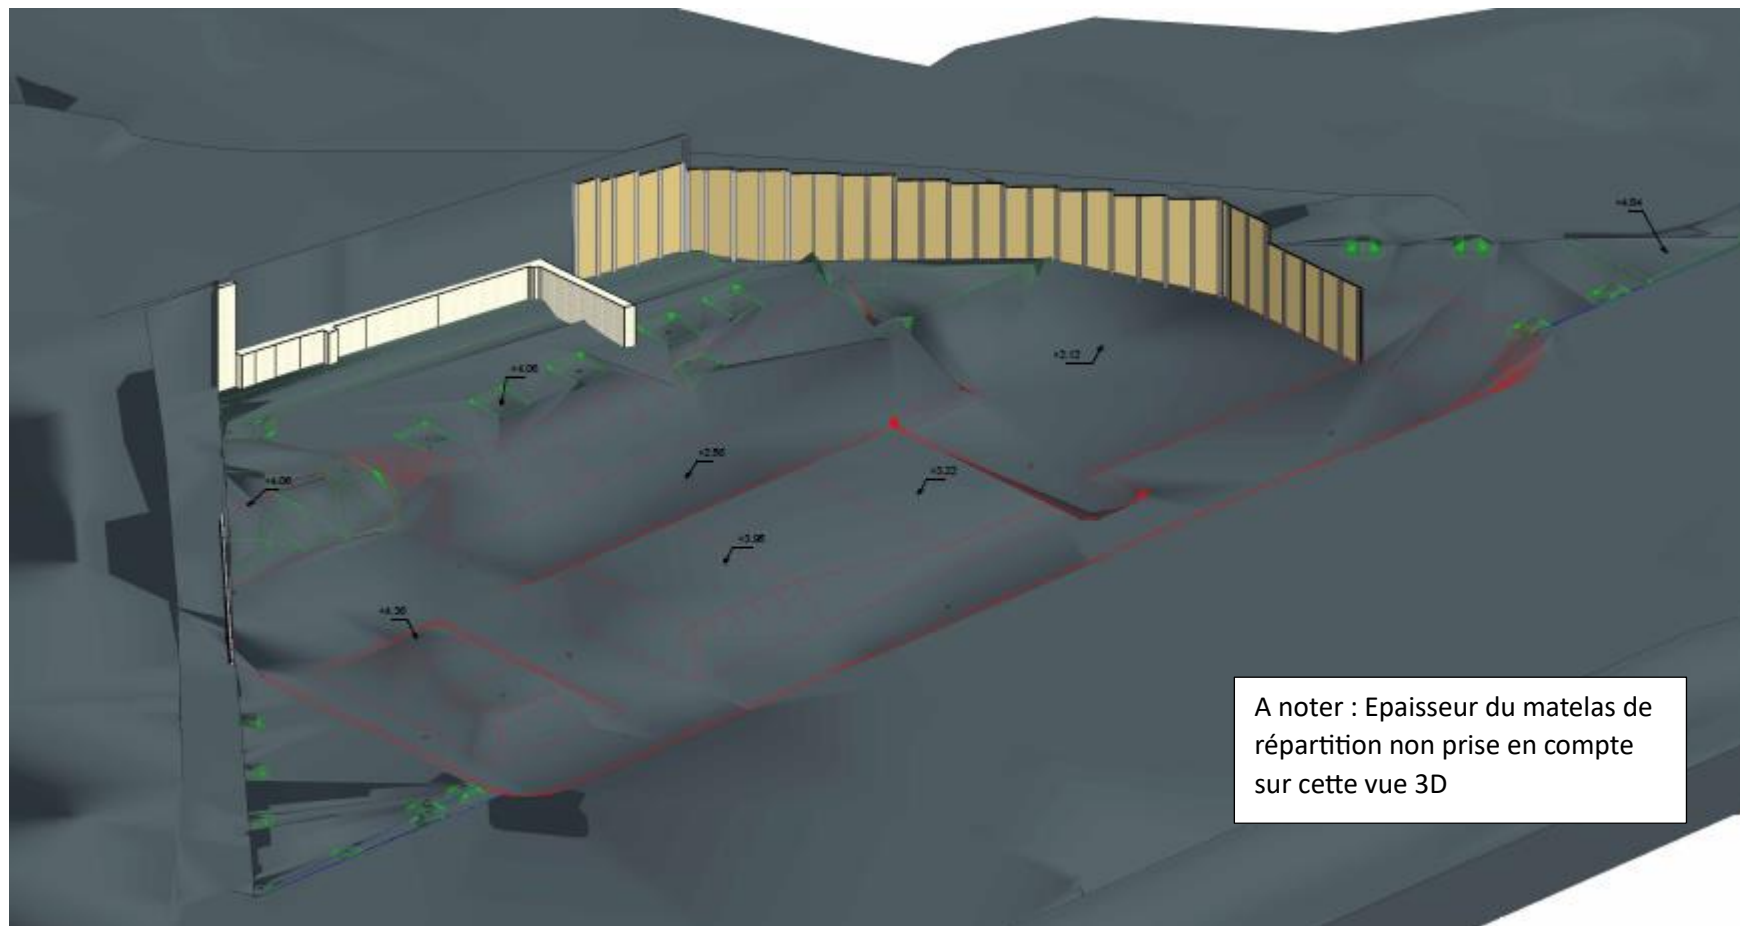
Extrait vue 3D des terrassements plan 2107 PRO Mai 2025
